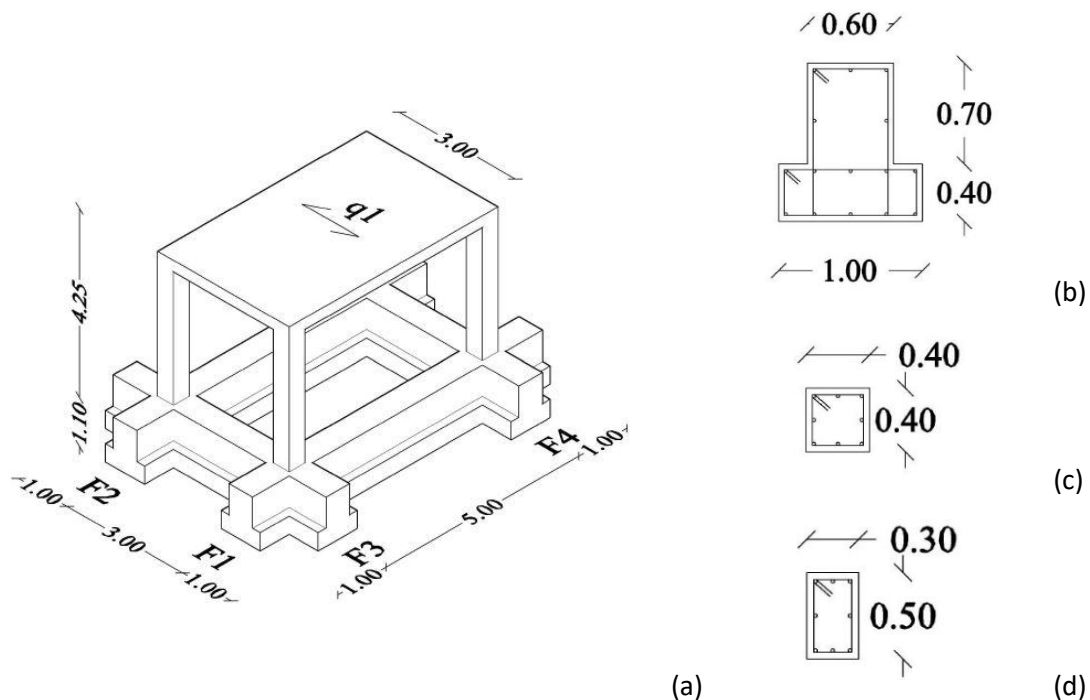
Telaio tridimensionale: dimensioni (in m) e carichi applicati (a); sezione trasversale trave di fondazione (b), colonne (c) e travi in elevazione (d).
